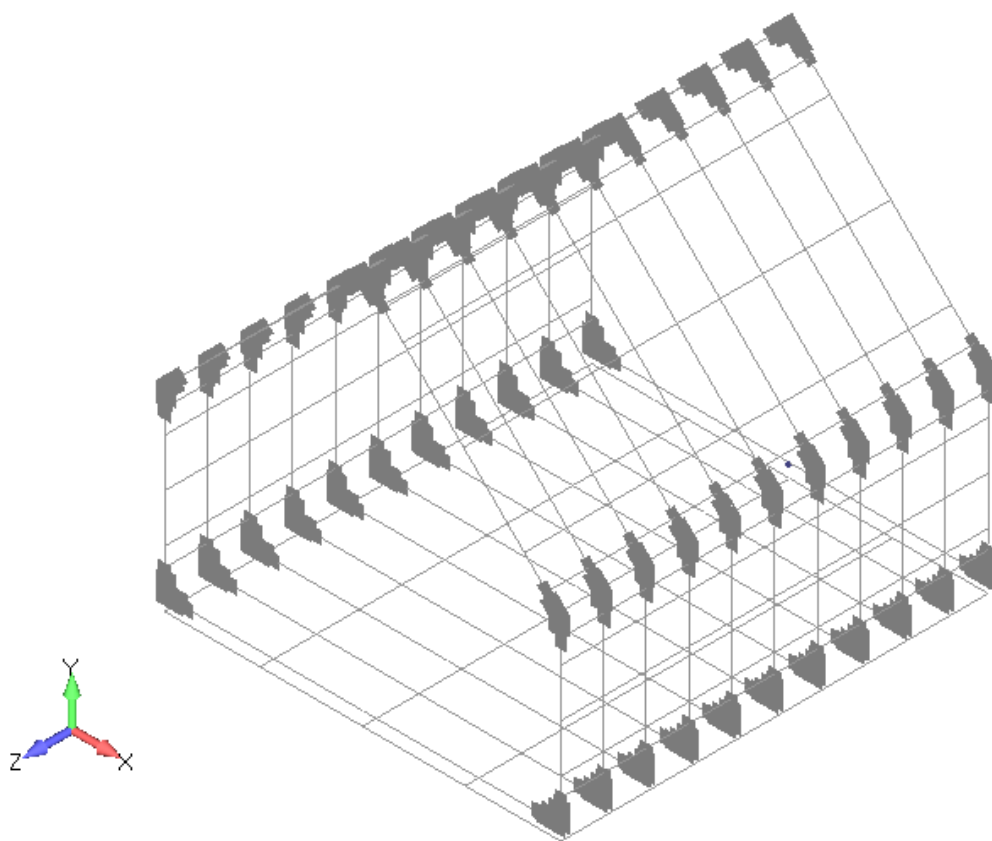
Конечно-элементная модель двускатного здания с углом наклона кровли 45 град.
